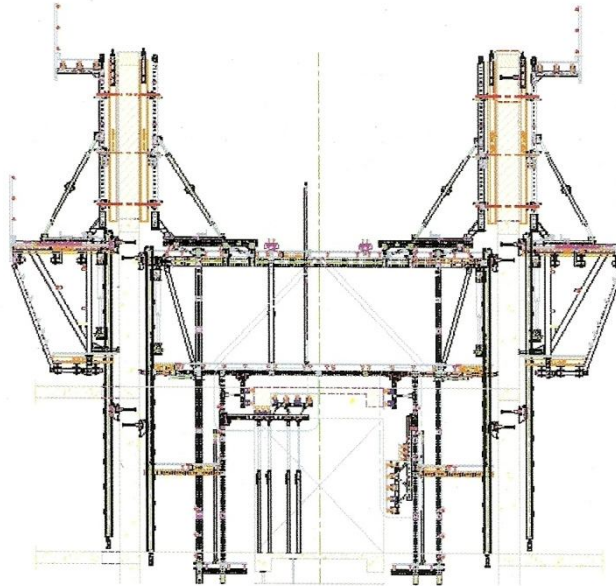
Cofragem de laje interior suspensa de uma plataforma auto-trepante (Peri, 2008)
